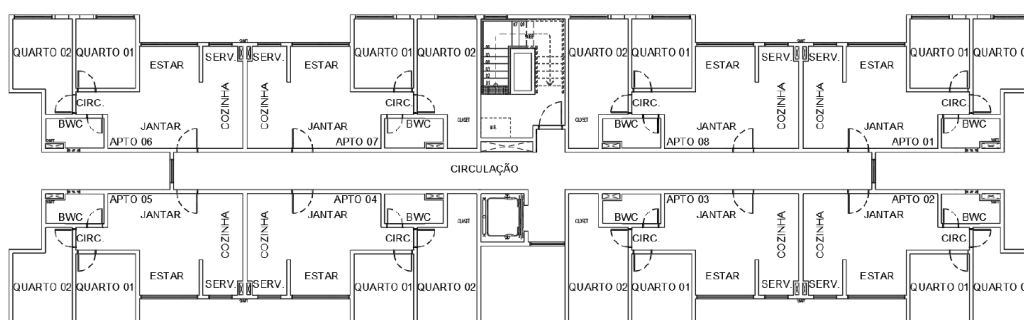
Planta baixa do pavimento tipo da edificação A (AUTOR, 2023).
